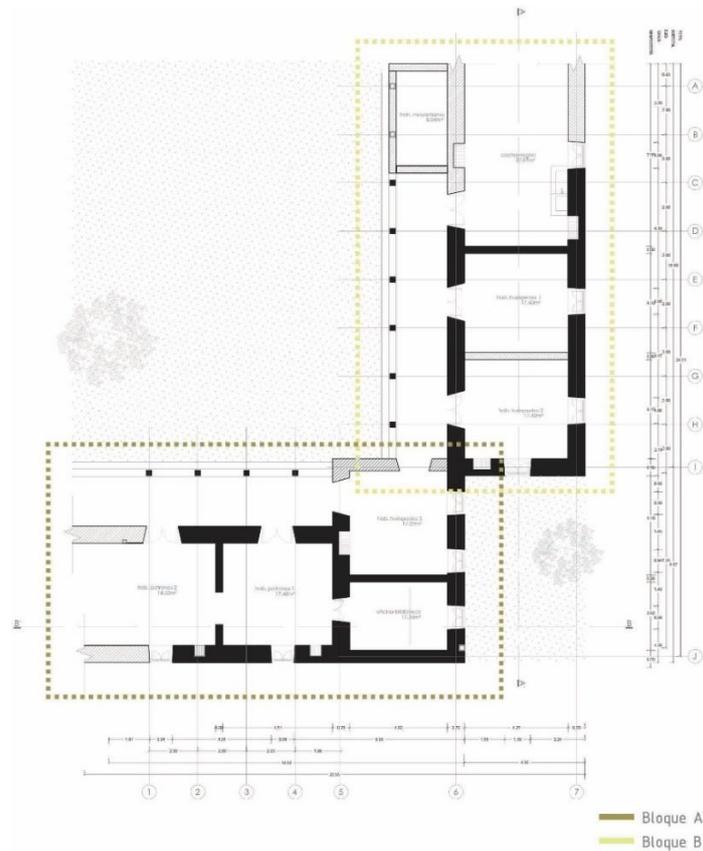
Levantamiento estado actual Hacienda San Ruiz Wikunto
